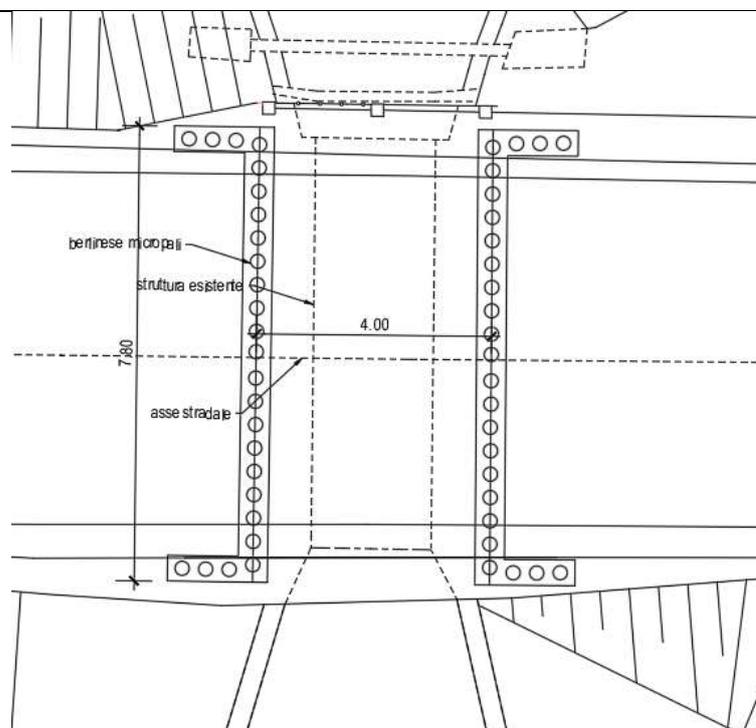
Planimetria sistemazione di progetto al km 58+700
